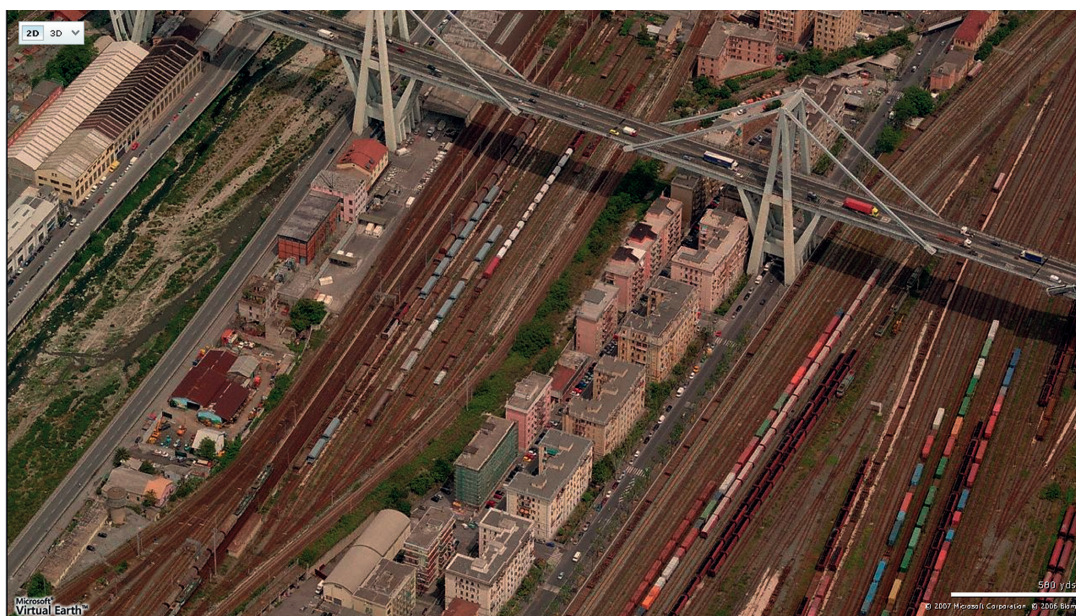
Particolare dell'area presso la stazione di Genova Sampierdarena oggetto di intervento.
